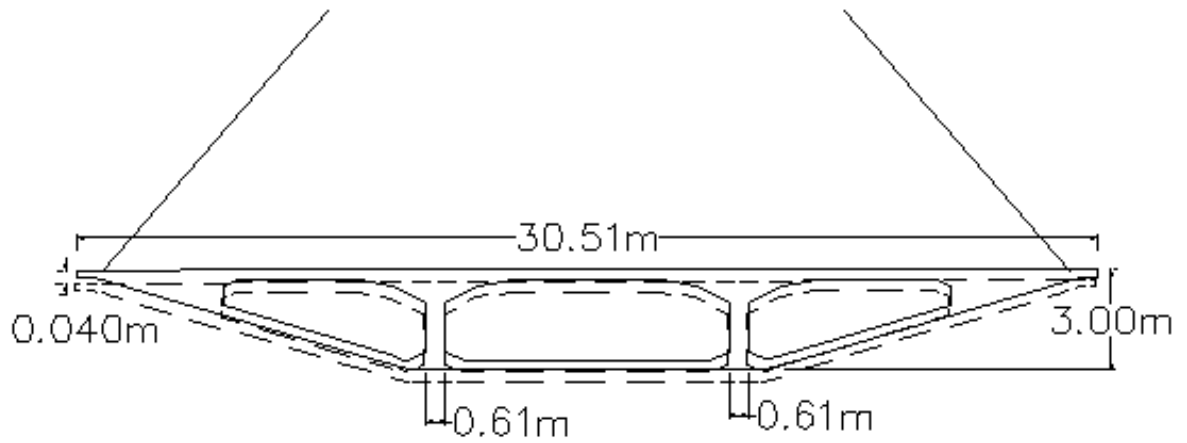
Sección transversal Tricelular-Lateral Deformada. Fuente: Autores
